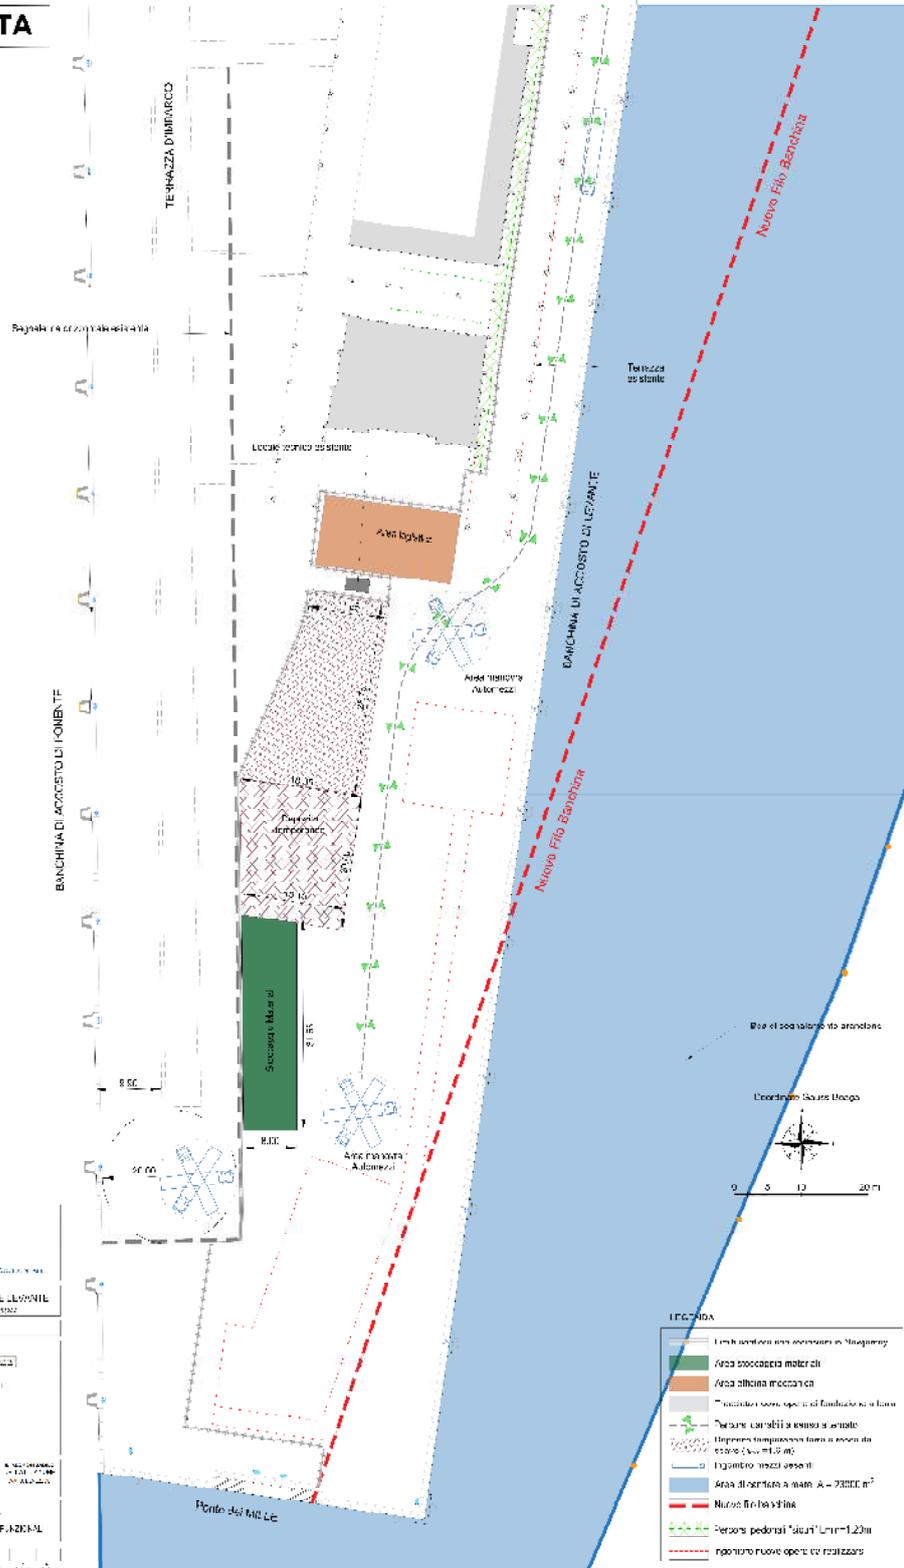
Planimetria di cantiere – logistica e aree funzionali
